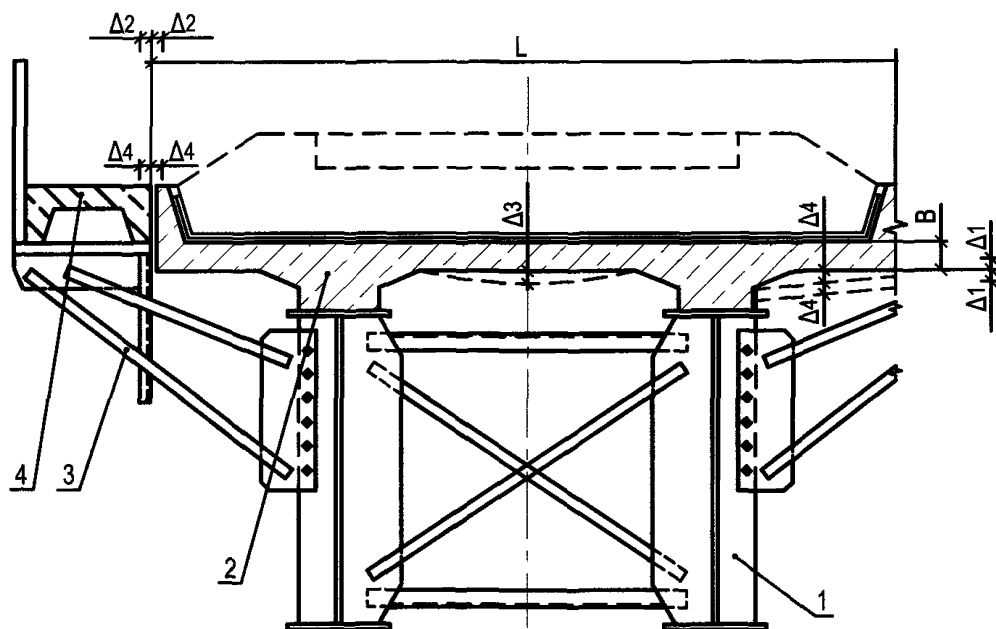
Схема устройства сборной железобетонной проезжей части сталежелезобетонного железнодорожного пролетного строения с указанием предельных отклонений
